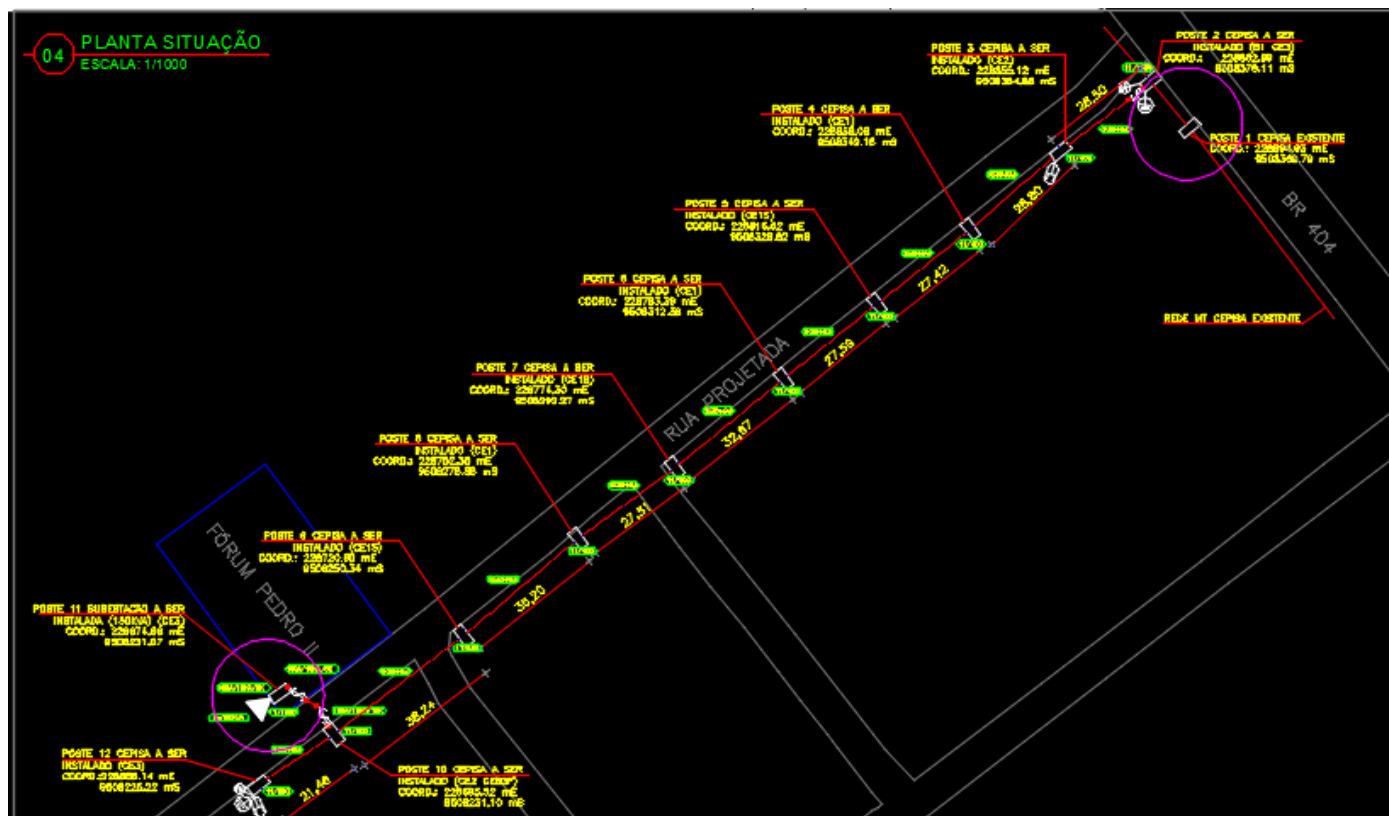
PLANTA DE SITUAÇÃO DO NOVO FÓRUM DE PEDRO II
